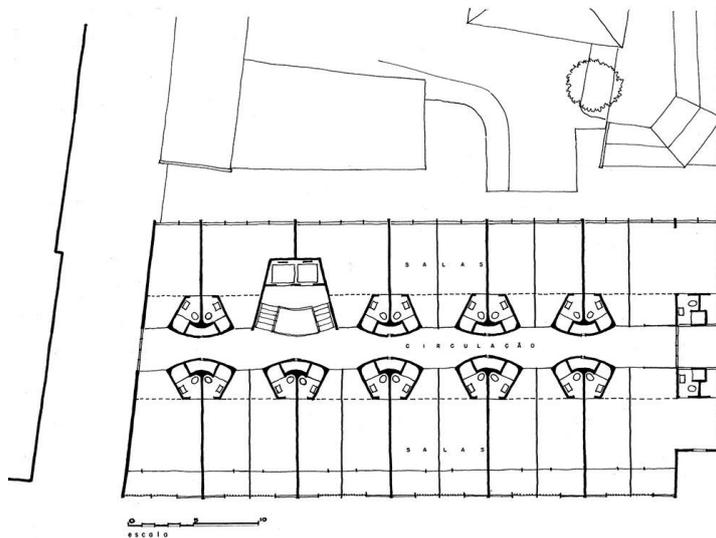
Planta baixa do pavimento tipo do Edifício Santo
